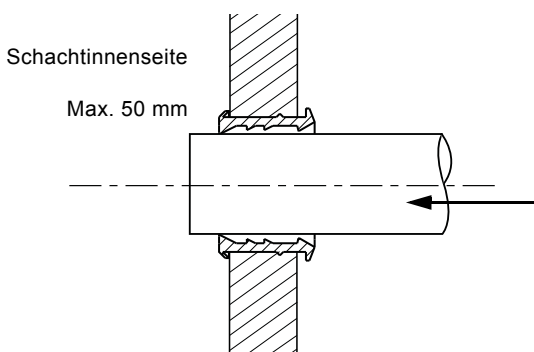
Rohr mit Manschette LM50/100, Seitenansicht
